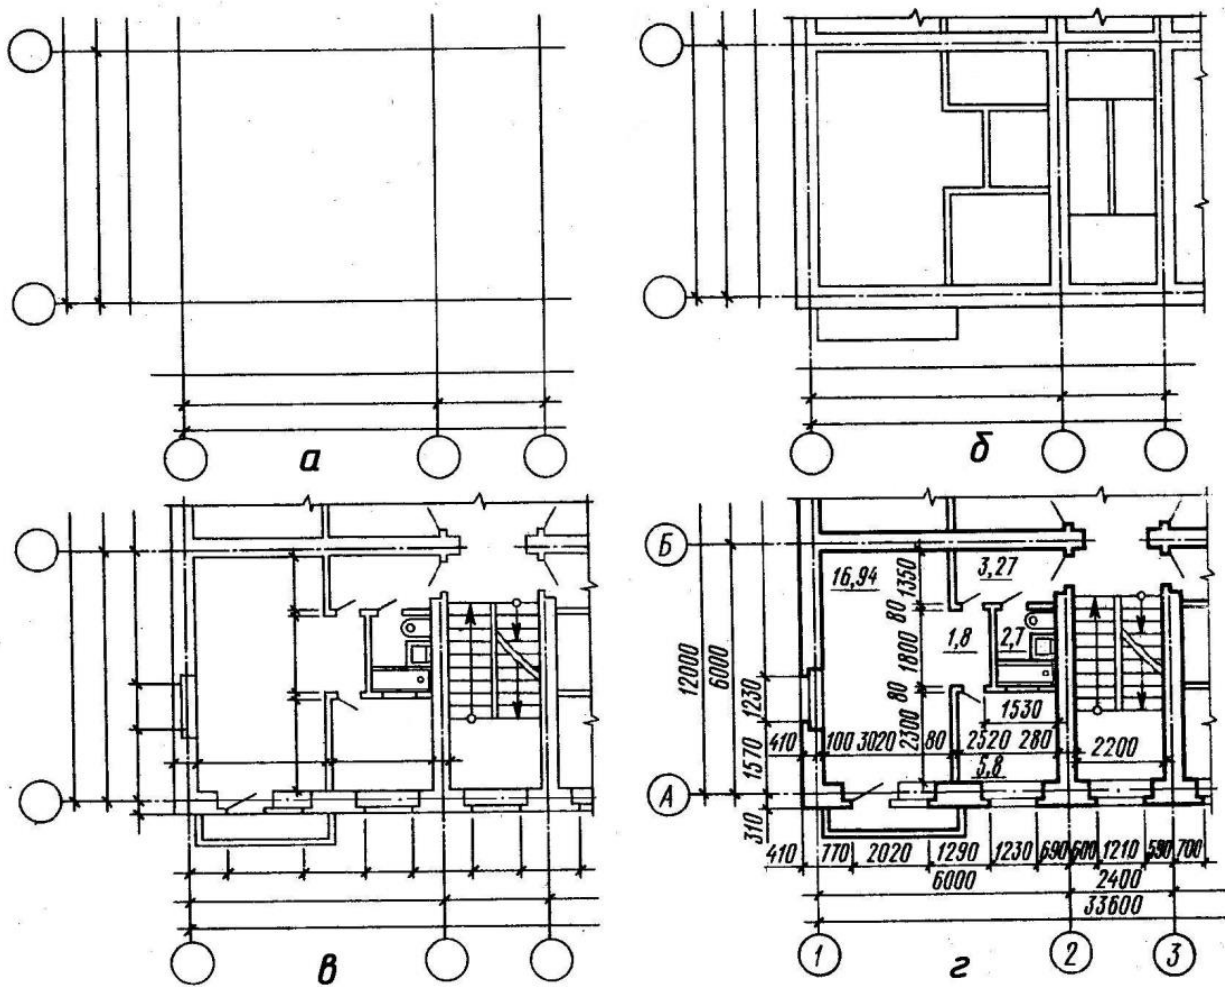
Послідовність (а, б, в, г) викреслювання плану будівлі
